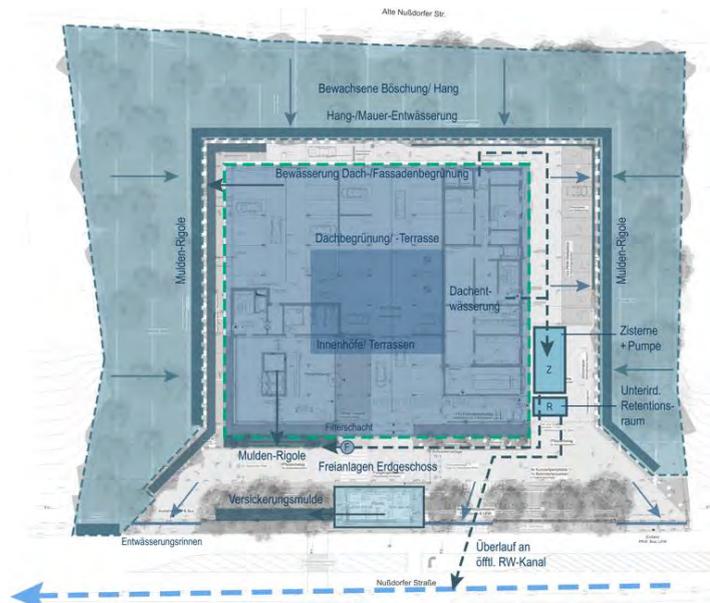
Entwässerungskonzeption Planstatt Senner – Stand 31.03.2025
